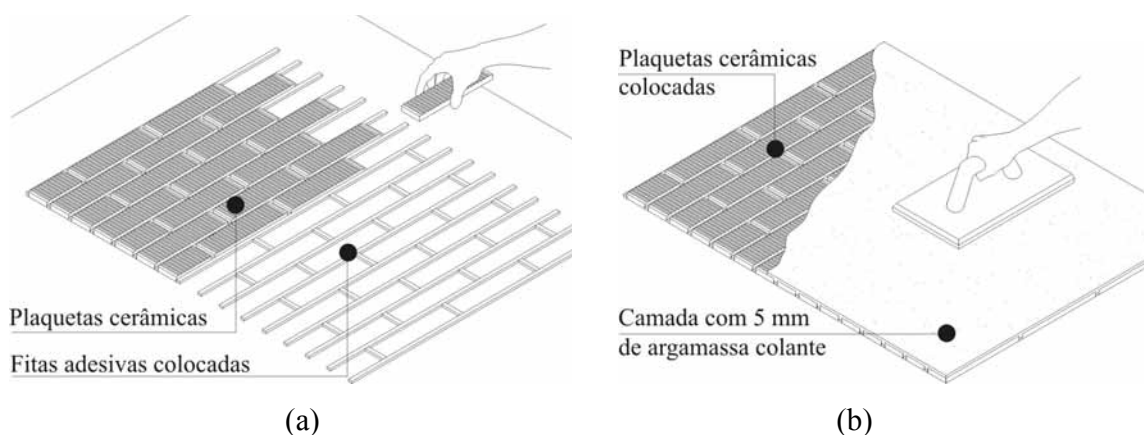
Colocação das plaquetas no fundo do molde e aplicação da argamassa colante sobre estas.
